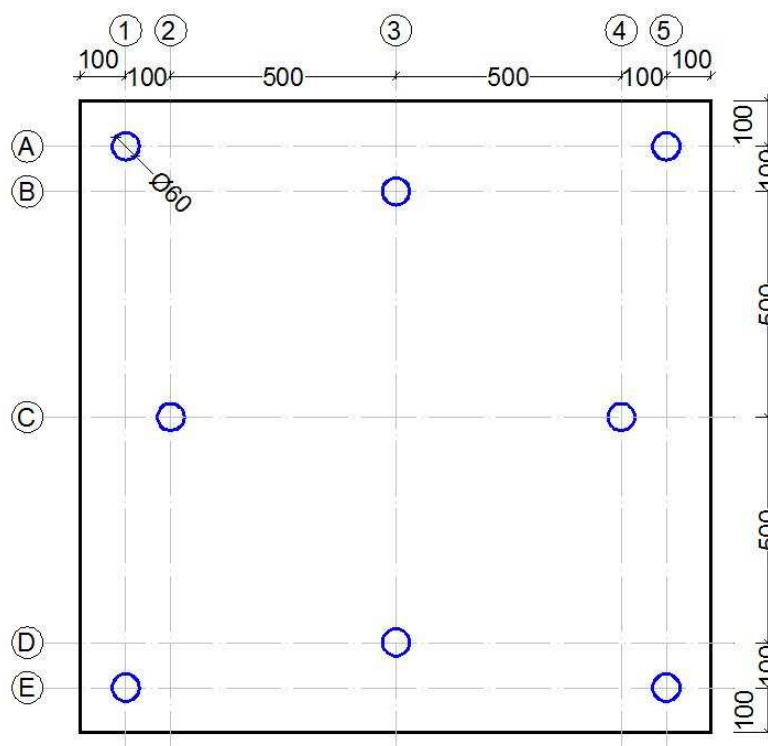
Planta baixa da FÔRMA_9 – (cotas em cm)
